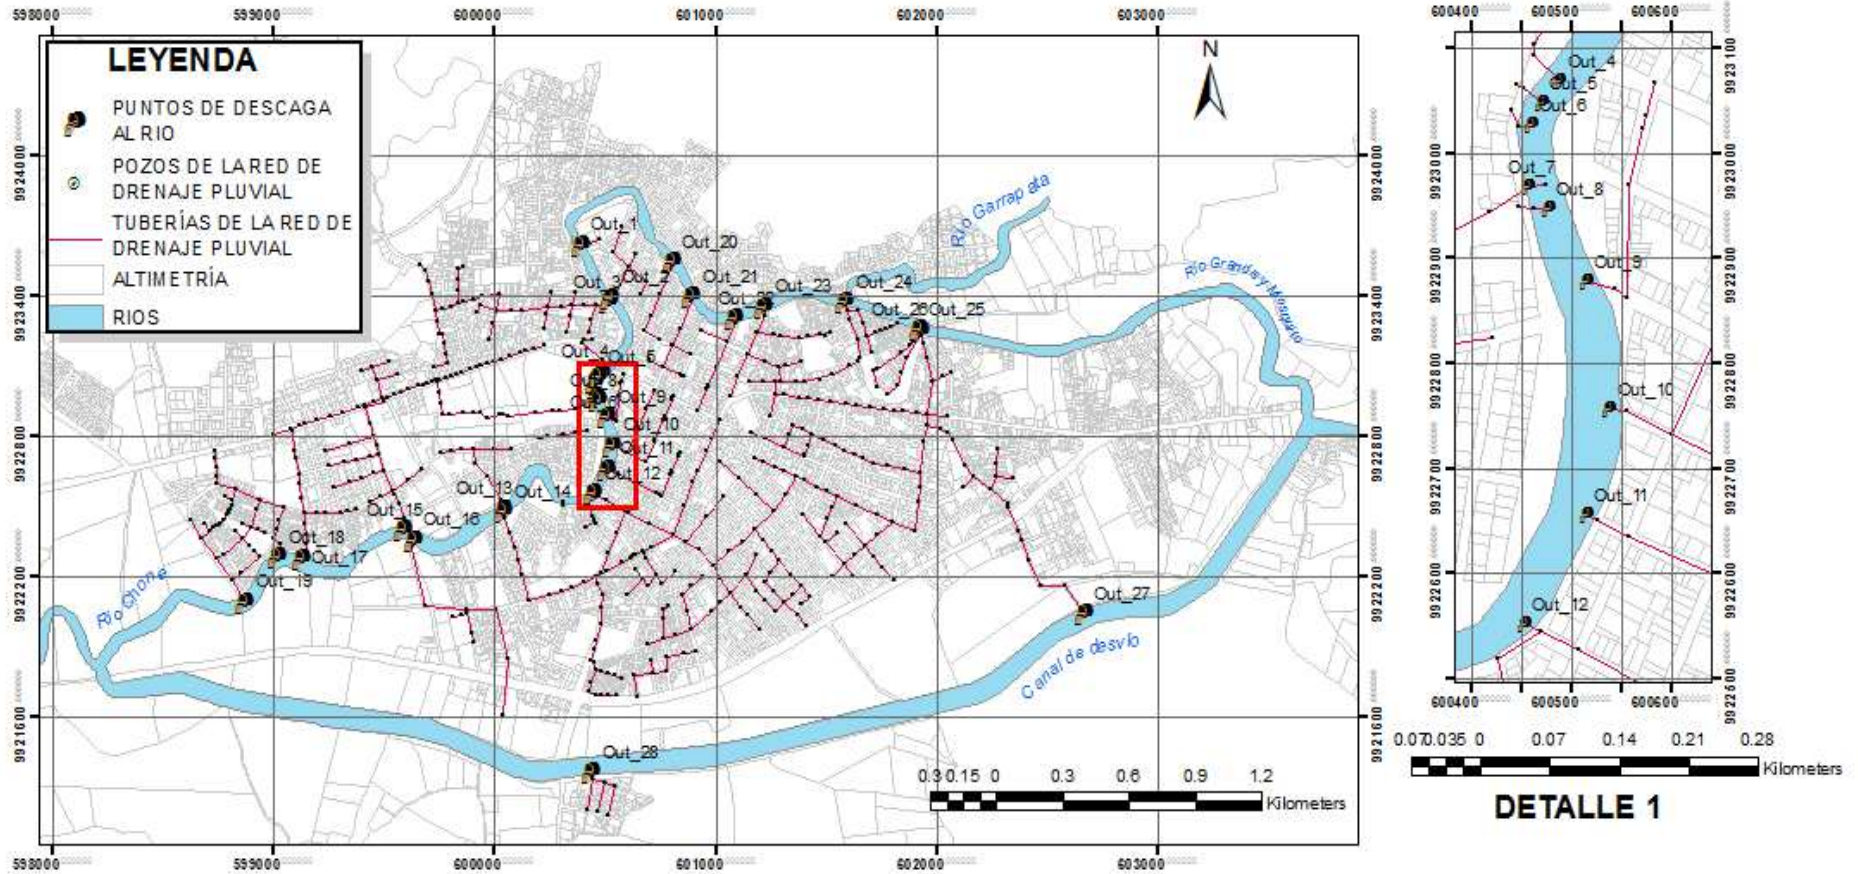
Red de drenaje pluvial futura de la ciudad de Chone.
